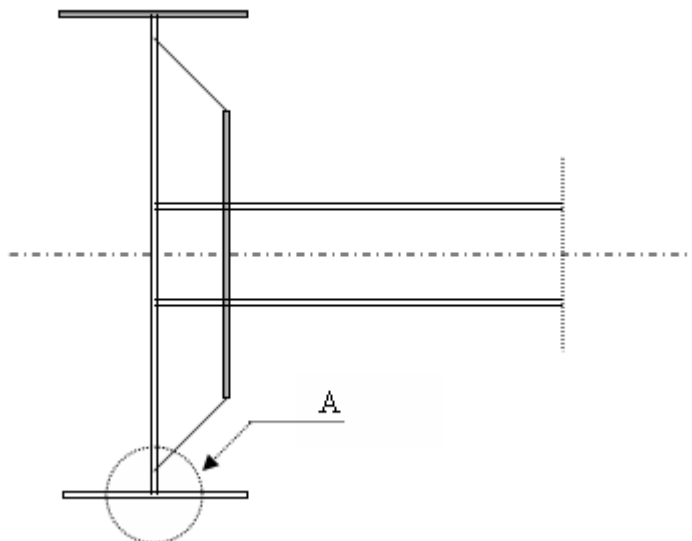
Raidisseur d'âme non soudé à la semelle
